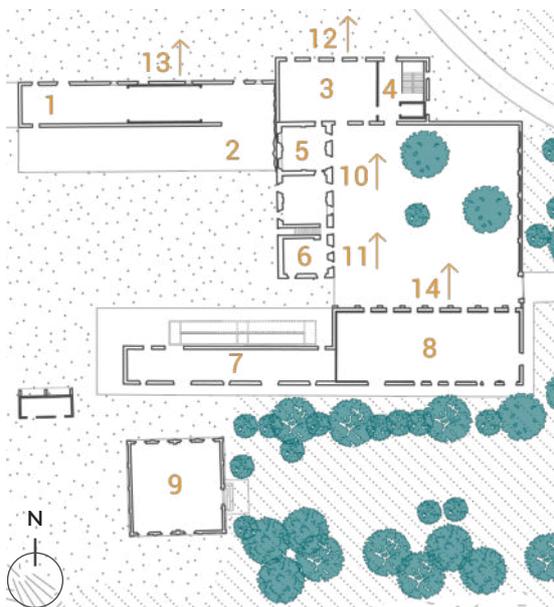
Planimetria Ex-galoppatoio militare progetto di fattibilità fondi PNRR, fonte: documentazione studio De Ferrari Architetti consegnata il 15/03/2023 + rielaborazione personale.
